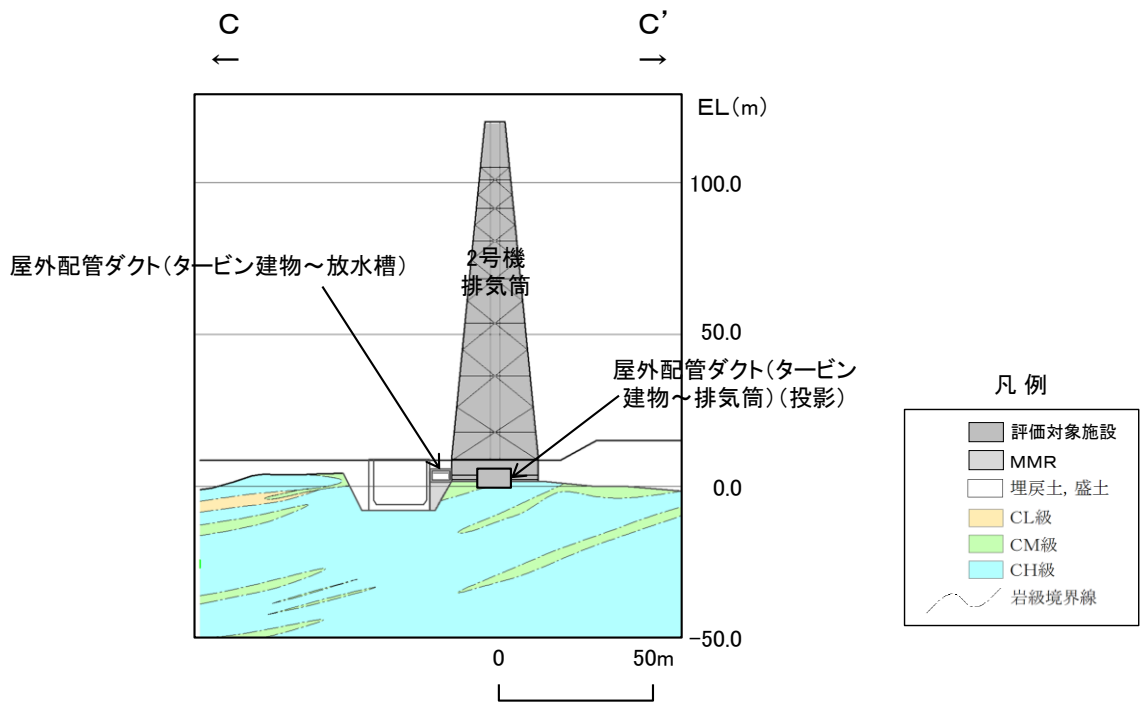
排気筒等の地質断面図 (C-C' 断面)
